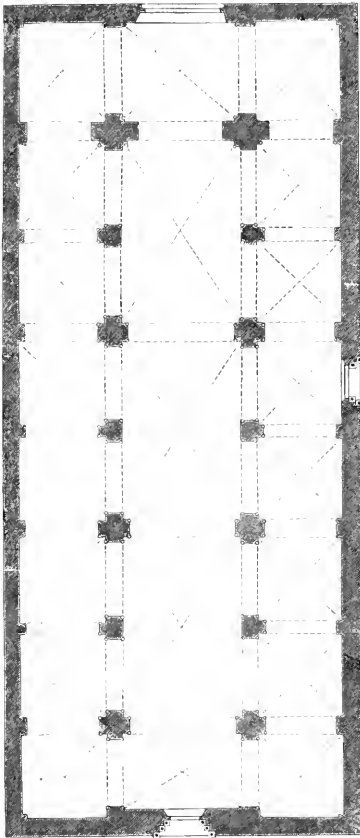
Grundriß der Kirche zu Sigolsheim.
